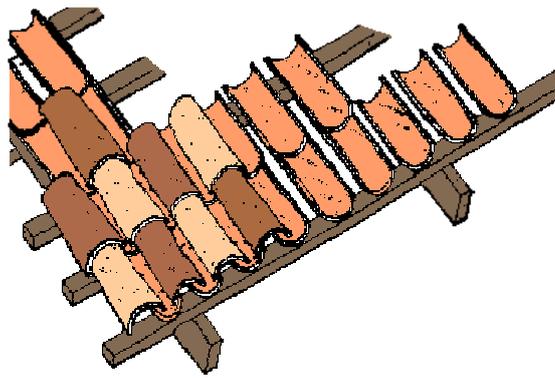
y 17. Detalles de tejas criollas y estructura de madera. Fuente: Internet. Tejados y Cubiertas.
